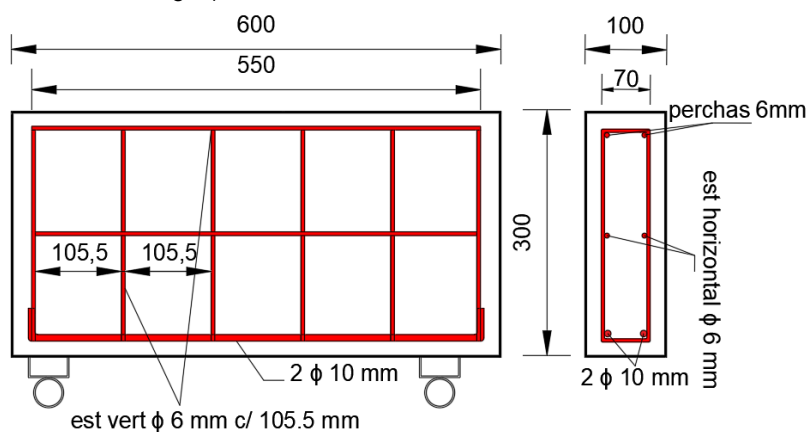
Dimensiones geométricas y detalle de armado de especímenes con armadura a corte mínima.
